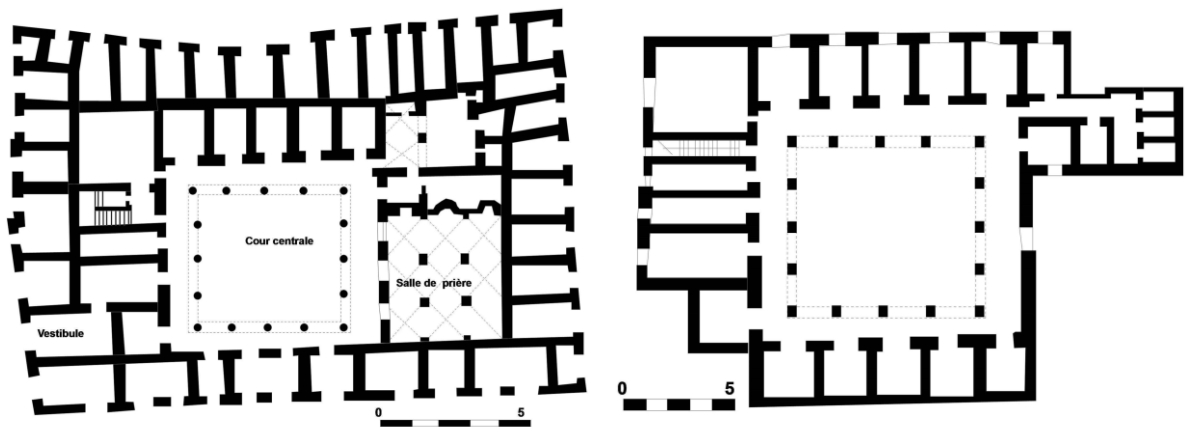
Vues en plan de la medersa el-Murādiya : le rez-de-chaussée à gauche et l'étage à droite
